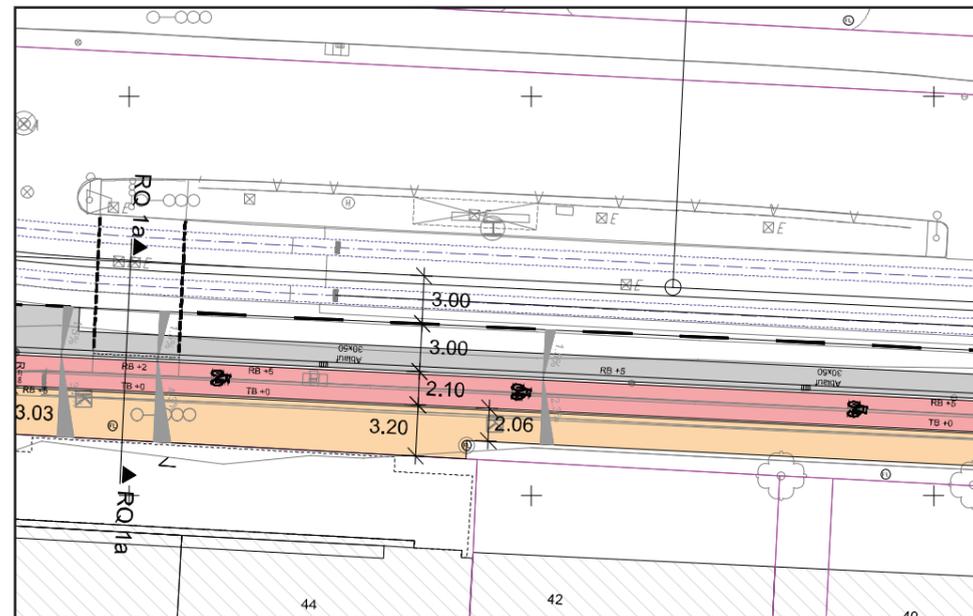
Lageplan Neugestaltung Heidelberger Straße
